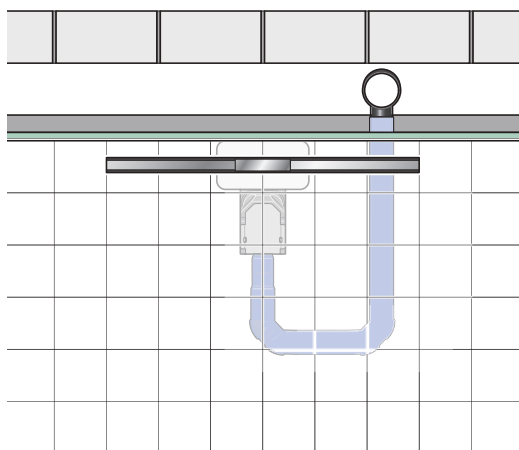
Vista in pianta canale per scarico doccia Geberit CleanLine davanti a sistema Geberit GIS/Duofix
